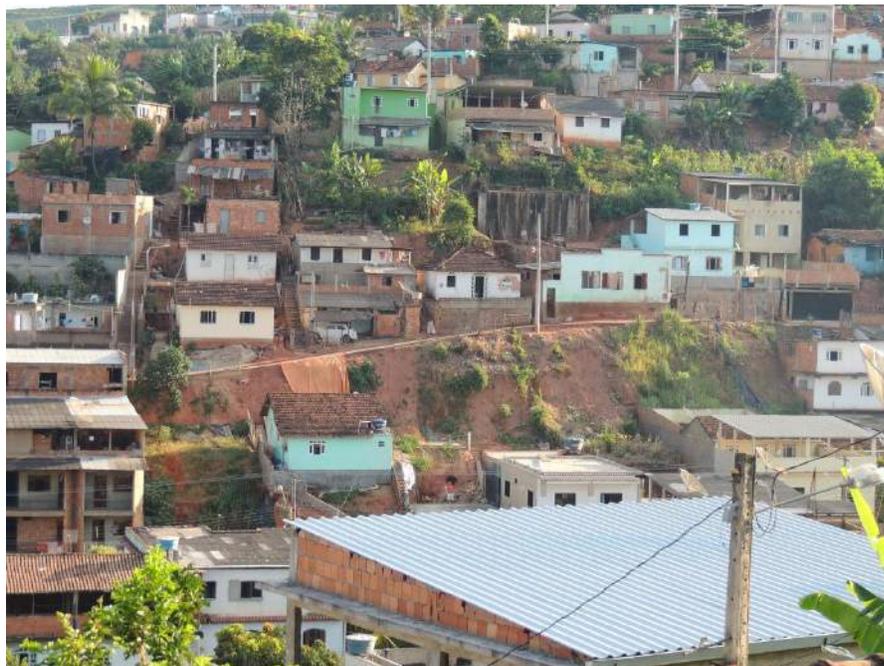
Talude instável a jusante da Rua Ernesto Zanelato.
